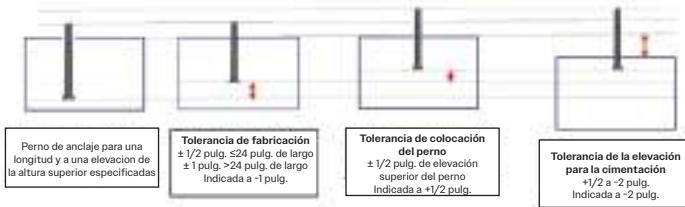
Ilustración de las tolerancias (marcadas con flechas rojas) para la fabricación, la colocación de la elevación del perno y la colocación de la elevación de la cimentación. Estas tolerancias se combinan para determinar la longitud del perno empotrado.
